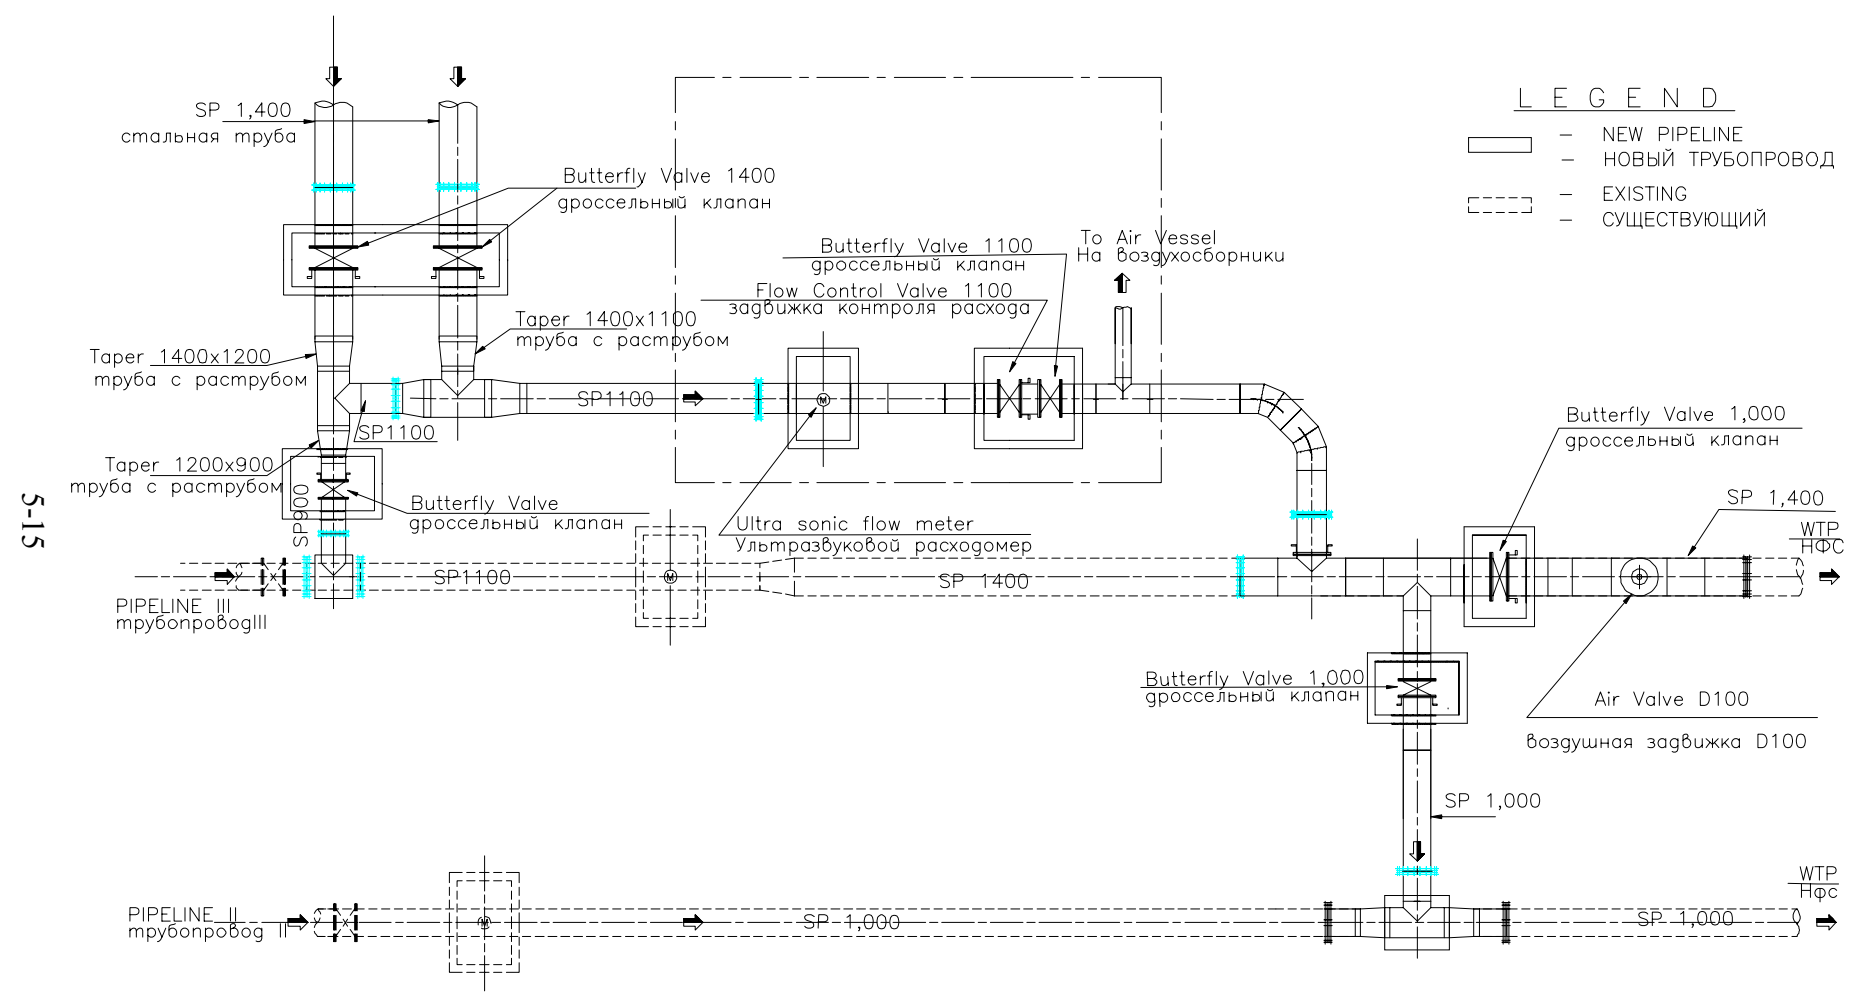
Соединение с трубопроводом подачи сырой воды
